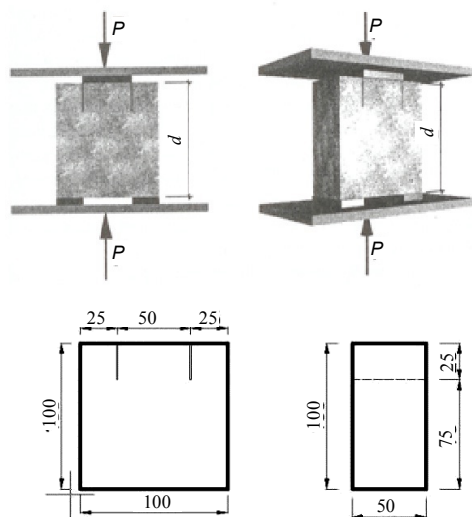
Образец с инициаторами трещины и схемой нагружения
